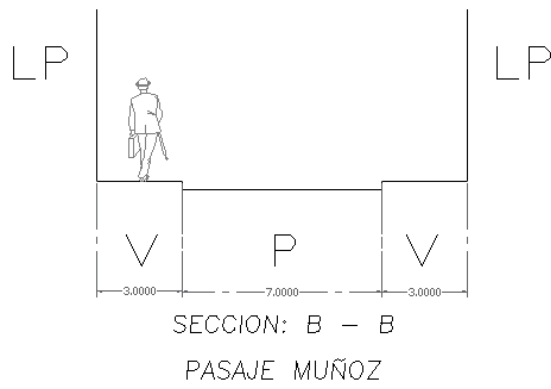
Sección del pasaje Muñoz. Fuente: elaboración propia
